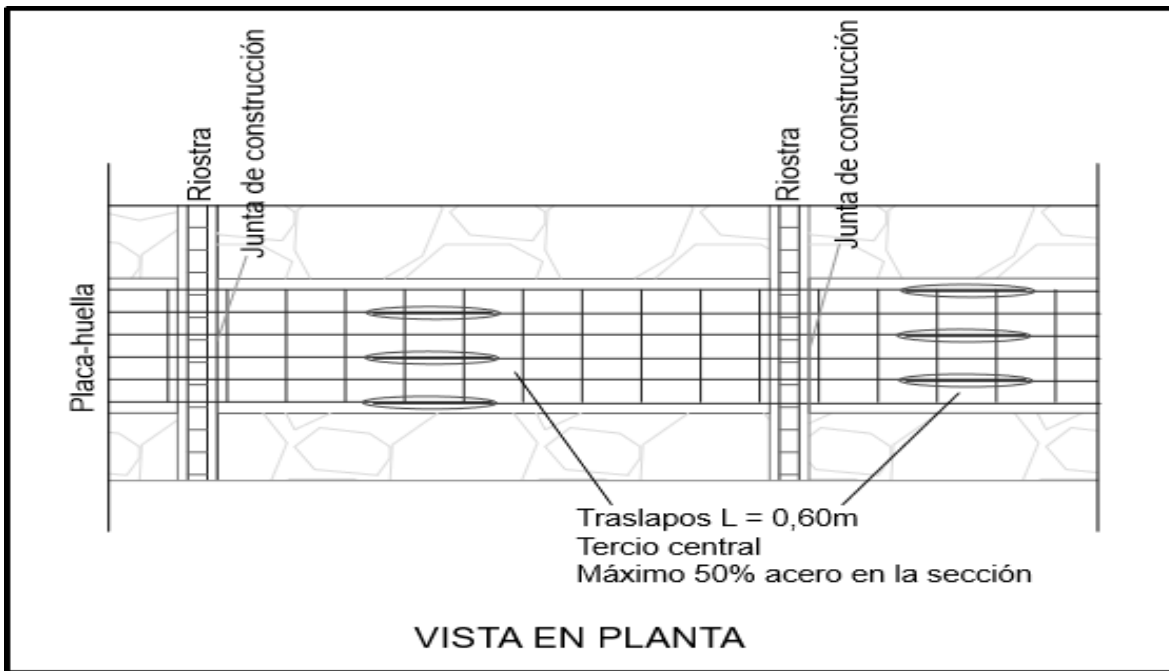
Junta transversal de construcción en la berma-cuneta. Fuente: Guía de
